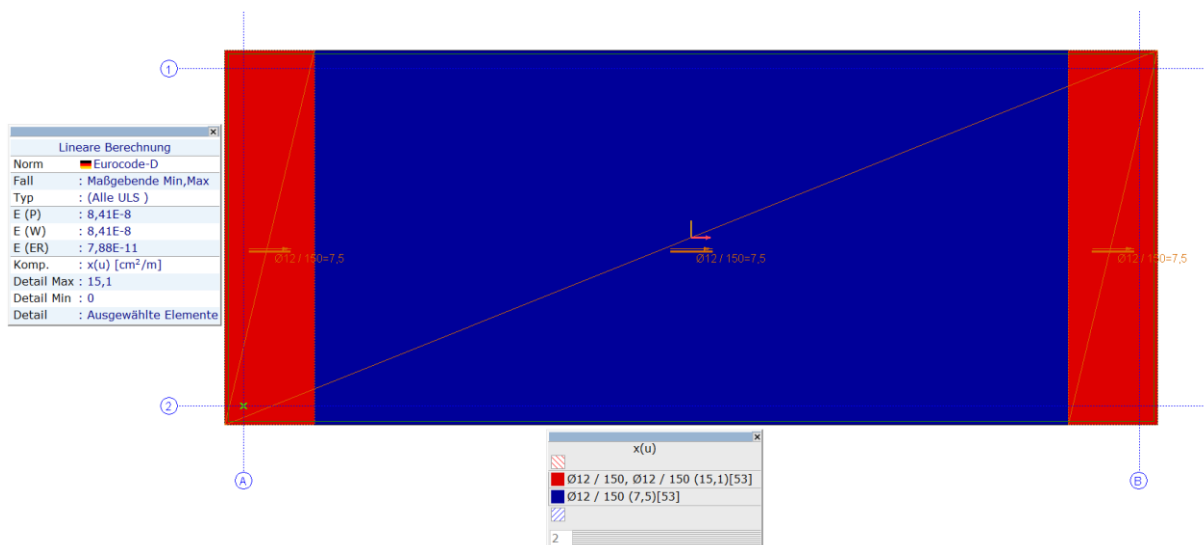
Entworfenere untere Bewehrung in lokaler x-Richtung
